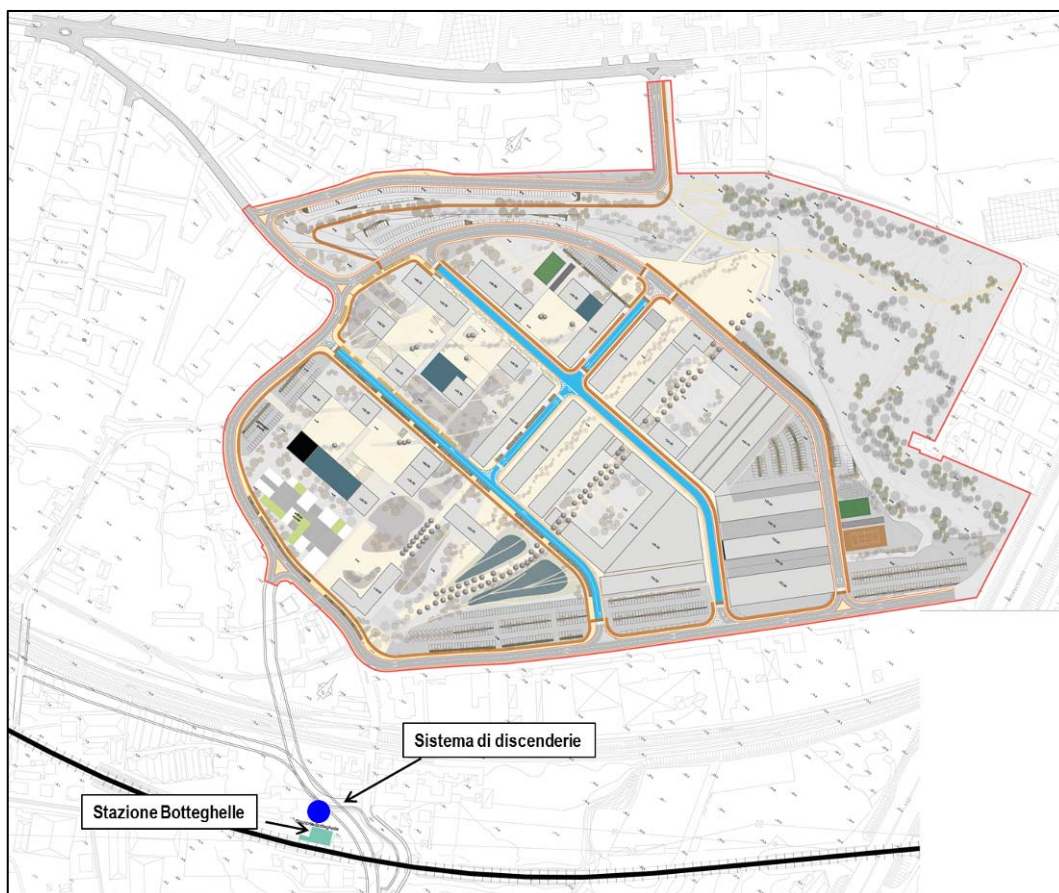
Individuazione planimetria del sistema di discenderie
